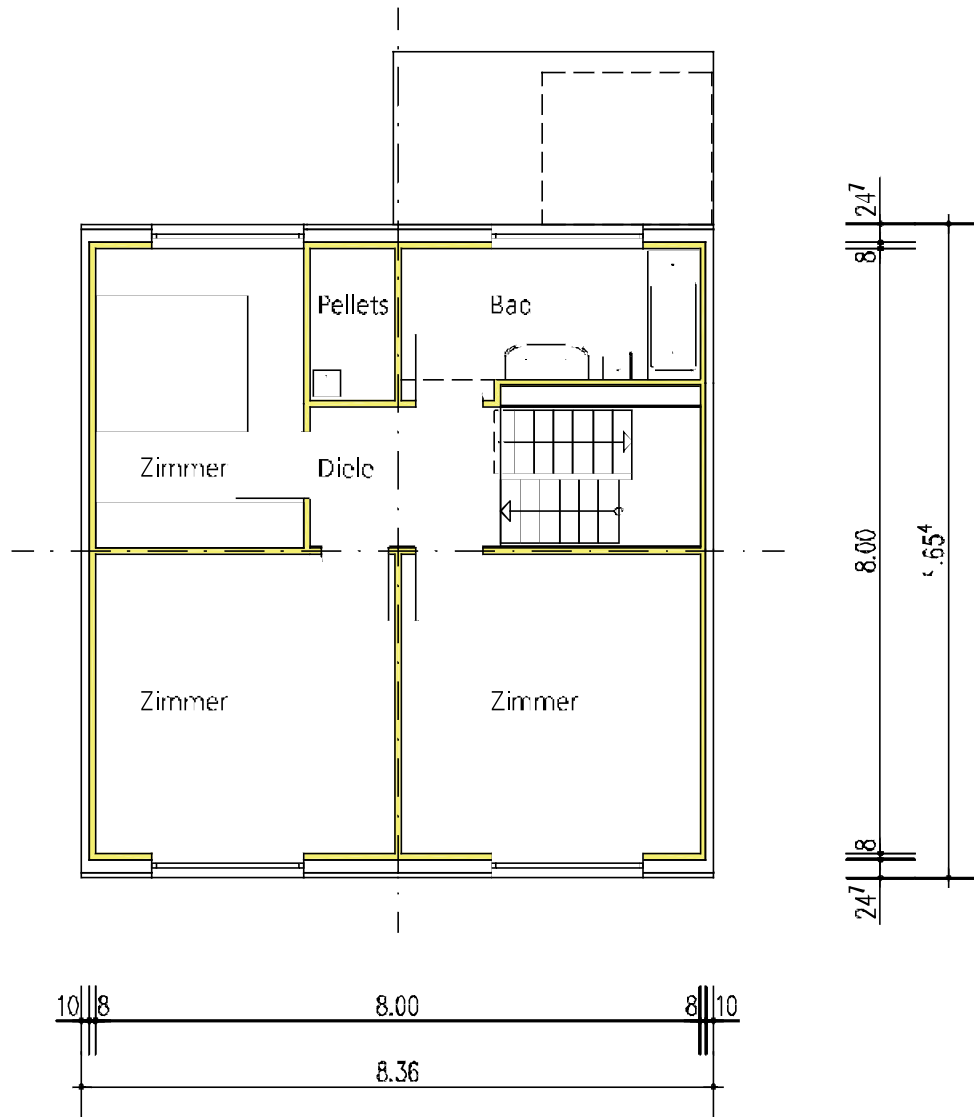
Grundriss OG, M 1:100
